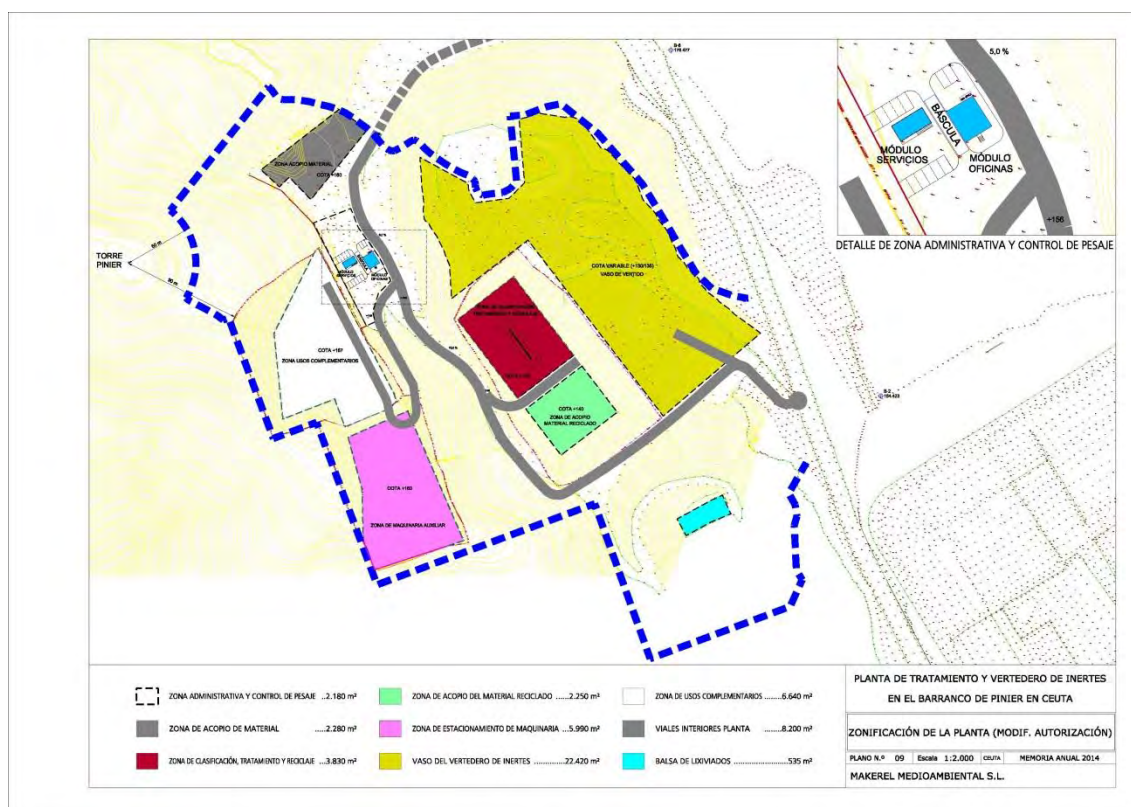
Planta de tratamiento y vertedero de inertes en el Barranco Pinier. Ceuta
